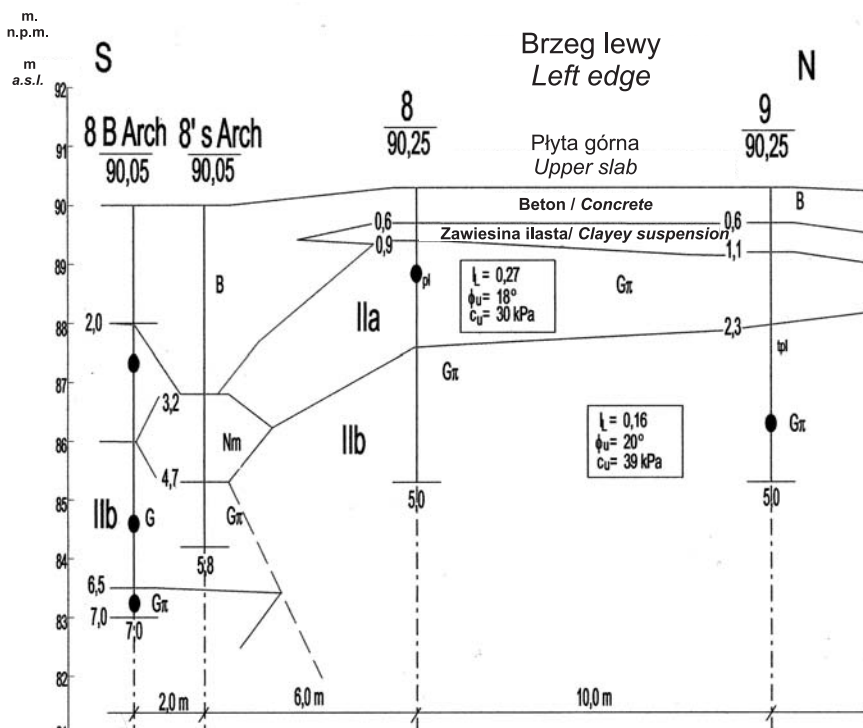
Przekrój geotechniczny podłoża jazu Zielisko w rejonie lewego przyczółka i płyty poszuru. Objaśnienia: przekrój geotechniczny, brzeg lewy, płyta górna, beton, B – beton, Ia – warstwa geotechniczna, zawiesina ilasta, G – glina, Gπ – glina pylasta, I_L – stopień plastyczności, Nm – namul, φ – kąt tarcia wewnętrznego, c_u – kohezja
